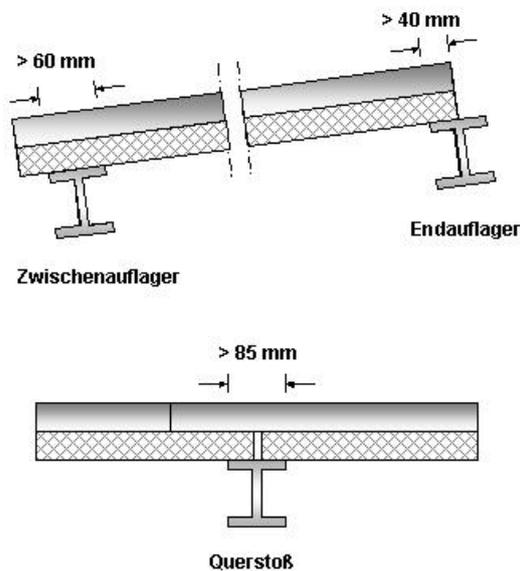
Mindestauflagerbreiten für Sandwichdächer
